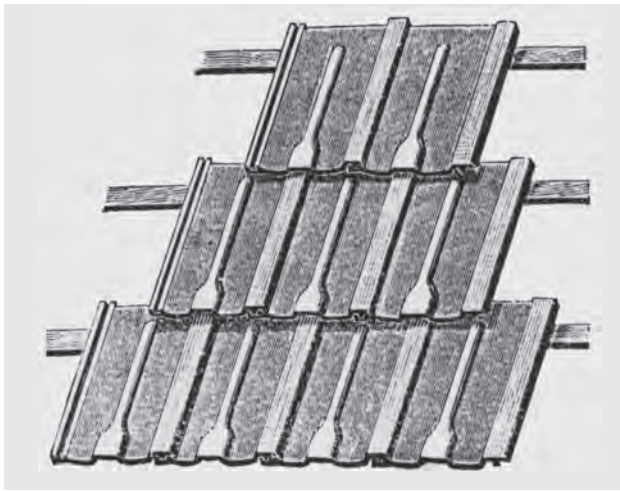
Strangfalzziegel System Schlickeisen mit unterer Haube
